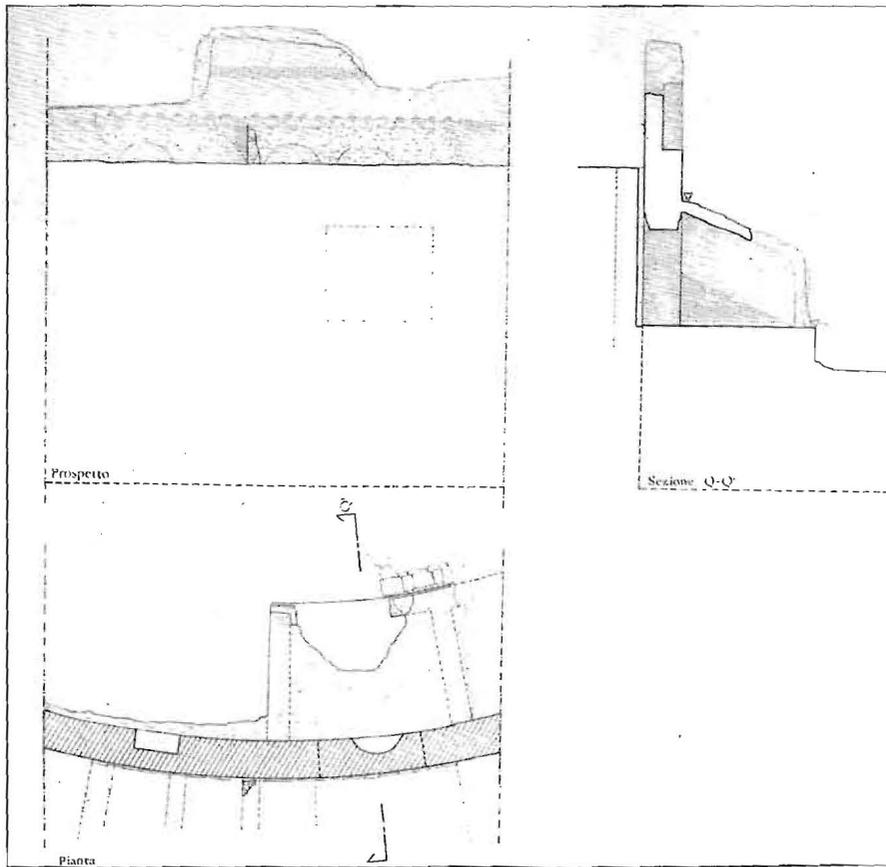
Pianta, prospetto e sezione dell'ambiente alla sinistra della cavea.
